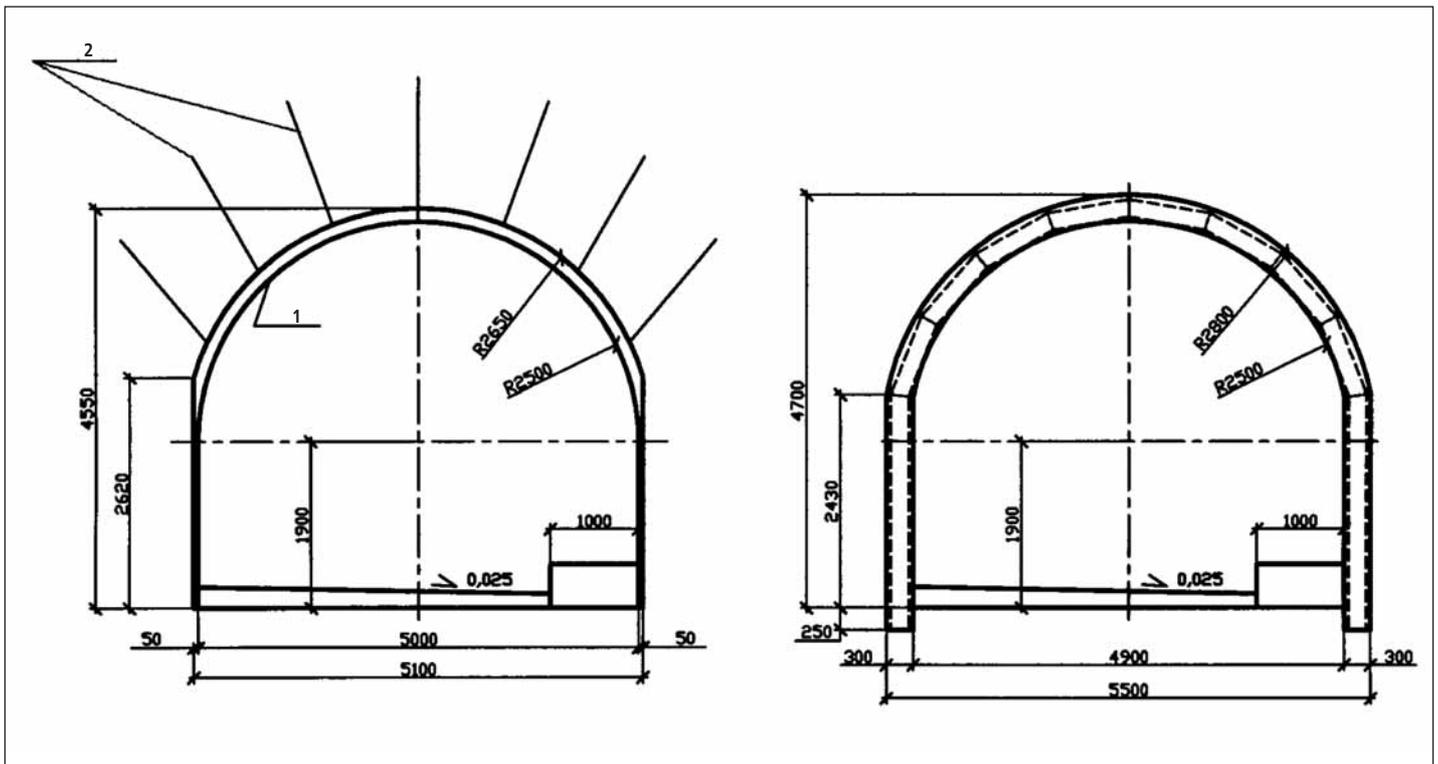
Типы обделок ДВШ. Назначение каждого аналогично назначению типов для тоннеля: 1 – набрызг-бетон; 2 – железобетонные анкеры
